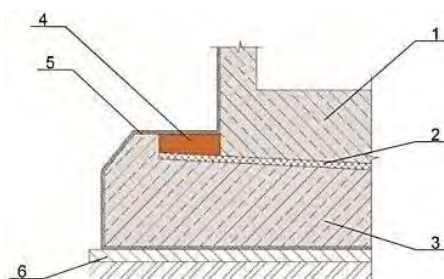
Схема сейсмоизолирующего скользящего пояса: 1) нижняя часть здания в уровне фундамента 2) фторопластовые пластины 3) фундамент 4) демпфер (песок крупный) 5) гидроизоляция 6) бетонная подготовка
